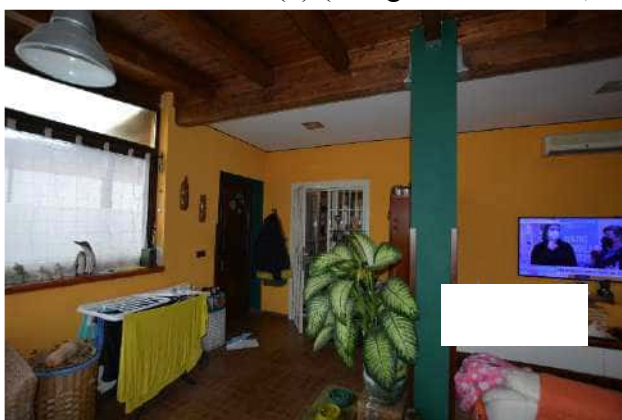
(Allegato 9) Ingresso nel portico chiuso a veranda
